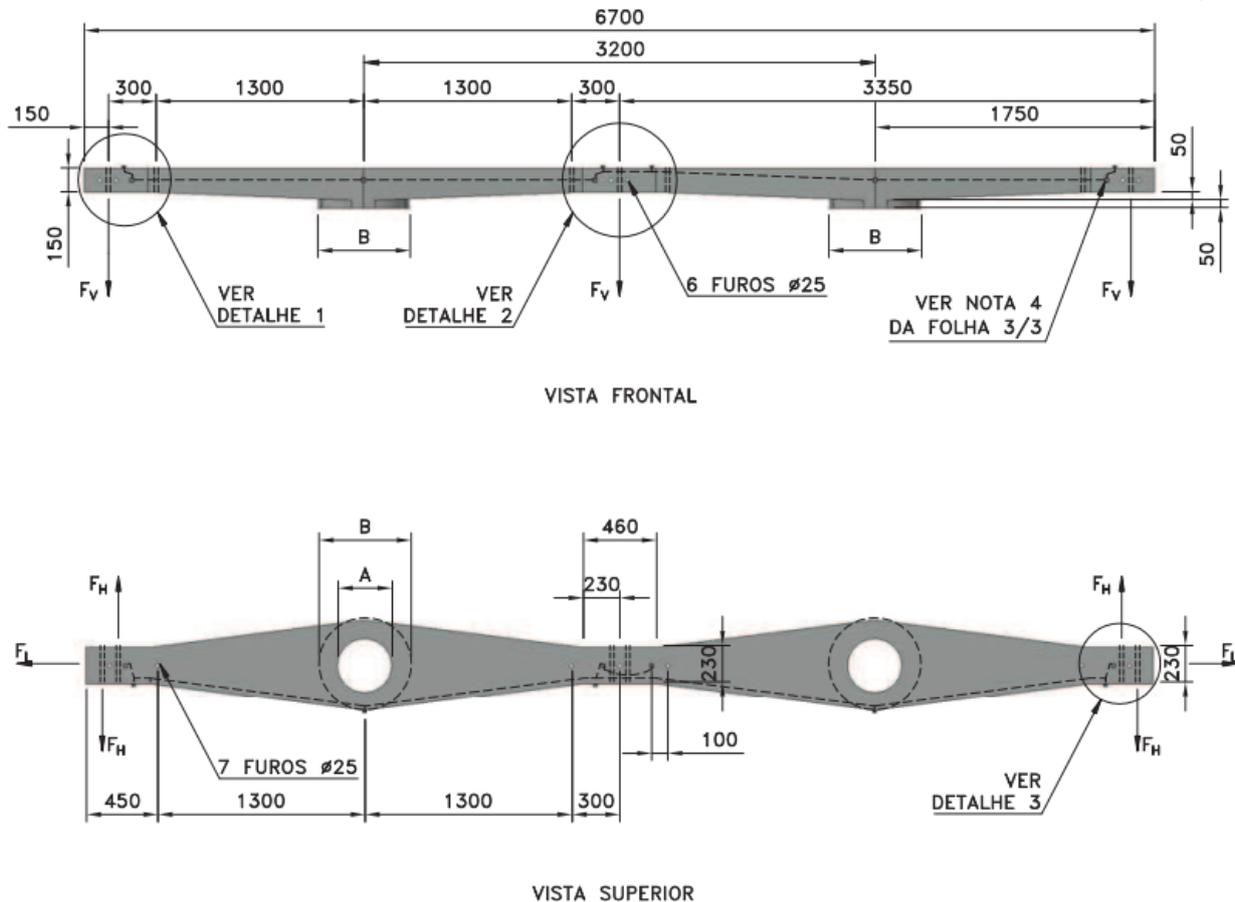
Cruzeta de concreto armado simples - tipo "H" – 6700mm
